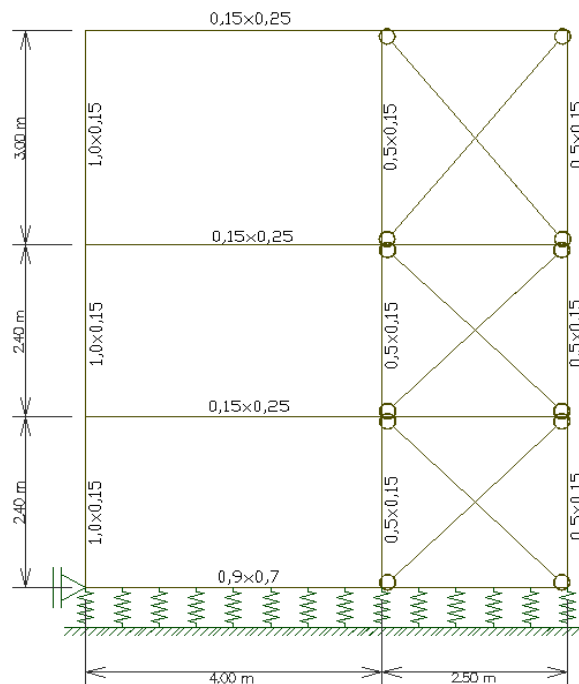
Dimensões e geometria das vigas e pilares do pórtico 5-5'
